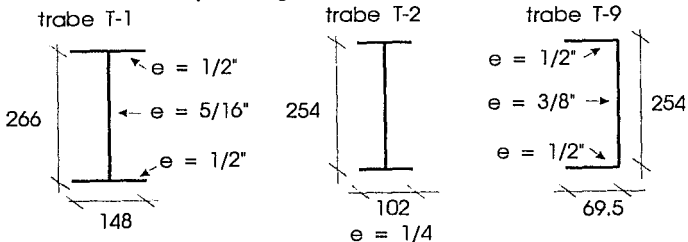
TIPOS DE TRAVES UTILIZADAS EN LA ESTRUCTURA METALICA
